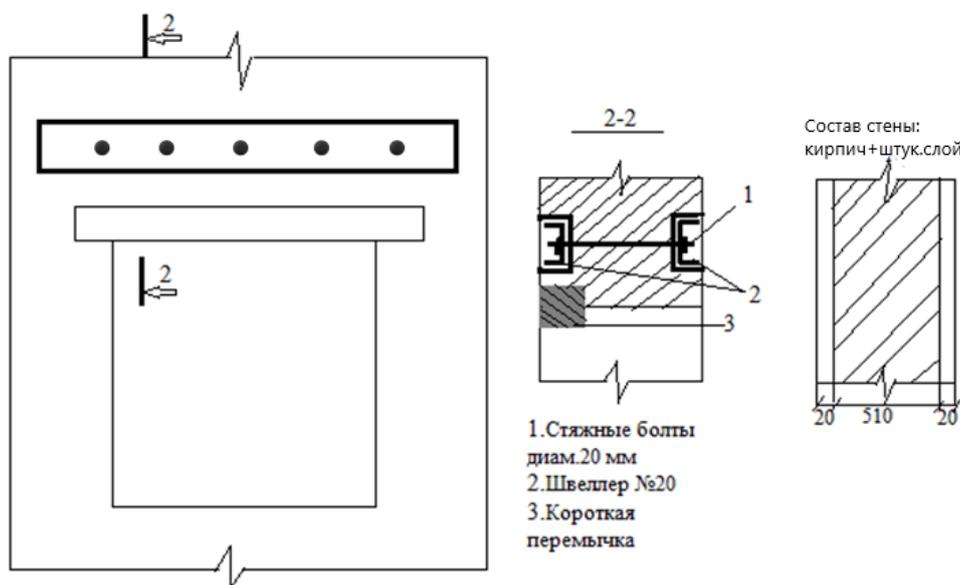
Усиление перемычки над оконным проемом металлическими балками.
